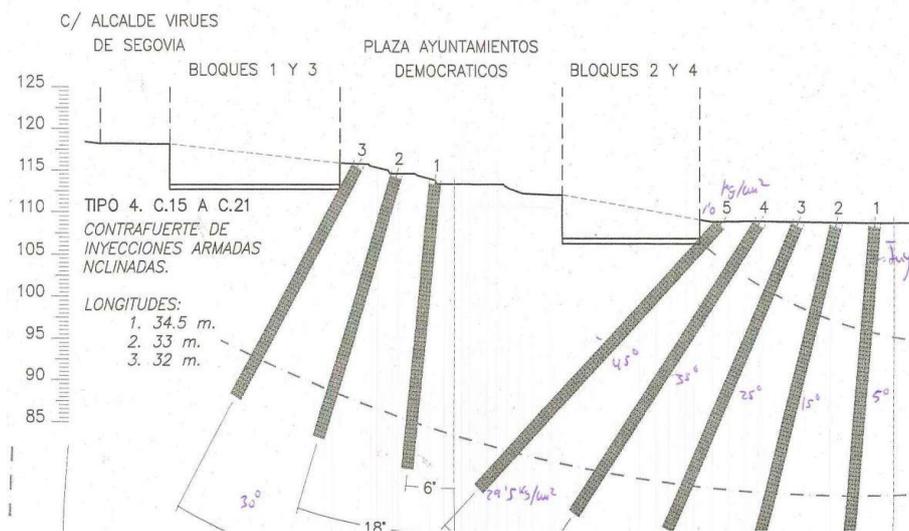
Sección que ilustra las inclinaciones de las inyecciones armadas y la intersección de la superficie de deslizamiento. Archivos del estudio de D. Emilio Yanes Bustamante (2011)
